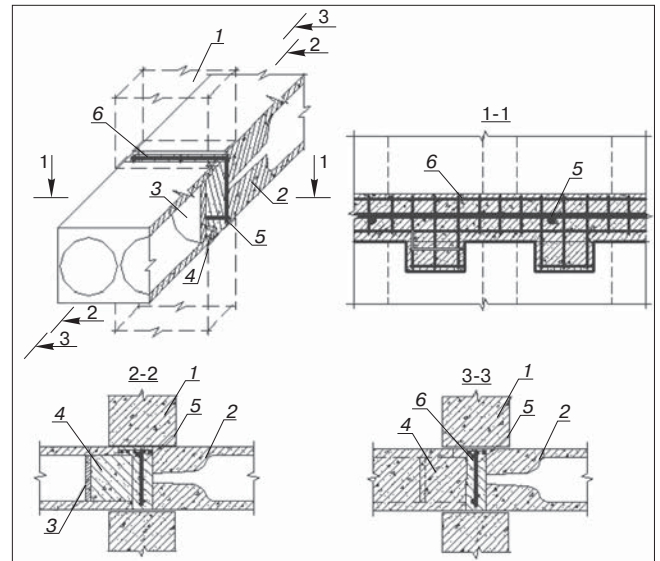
Платформенный сборно-монолитный стык: 1 – стеновая панель; 2 – многоячеечная плита перекрытия; 3 – бетонная диафрагма; 4 – бетон замоноличивания стыка; 5 – арматурный каркас; 6 – арматурная сетка
